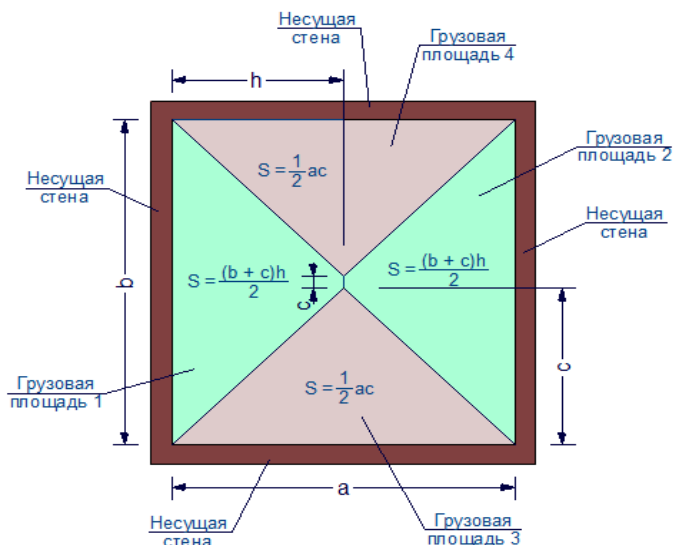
Схема определения грузовой площади ленточного фундамента (продольные и поперечные несущие стены)
